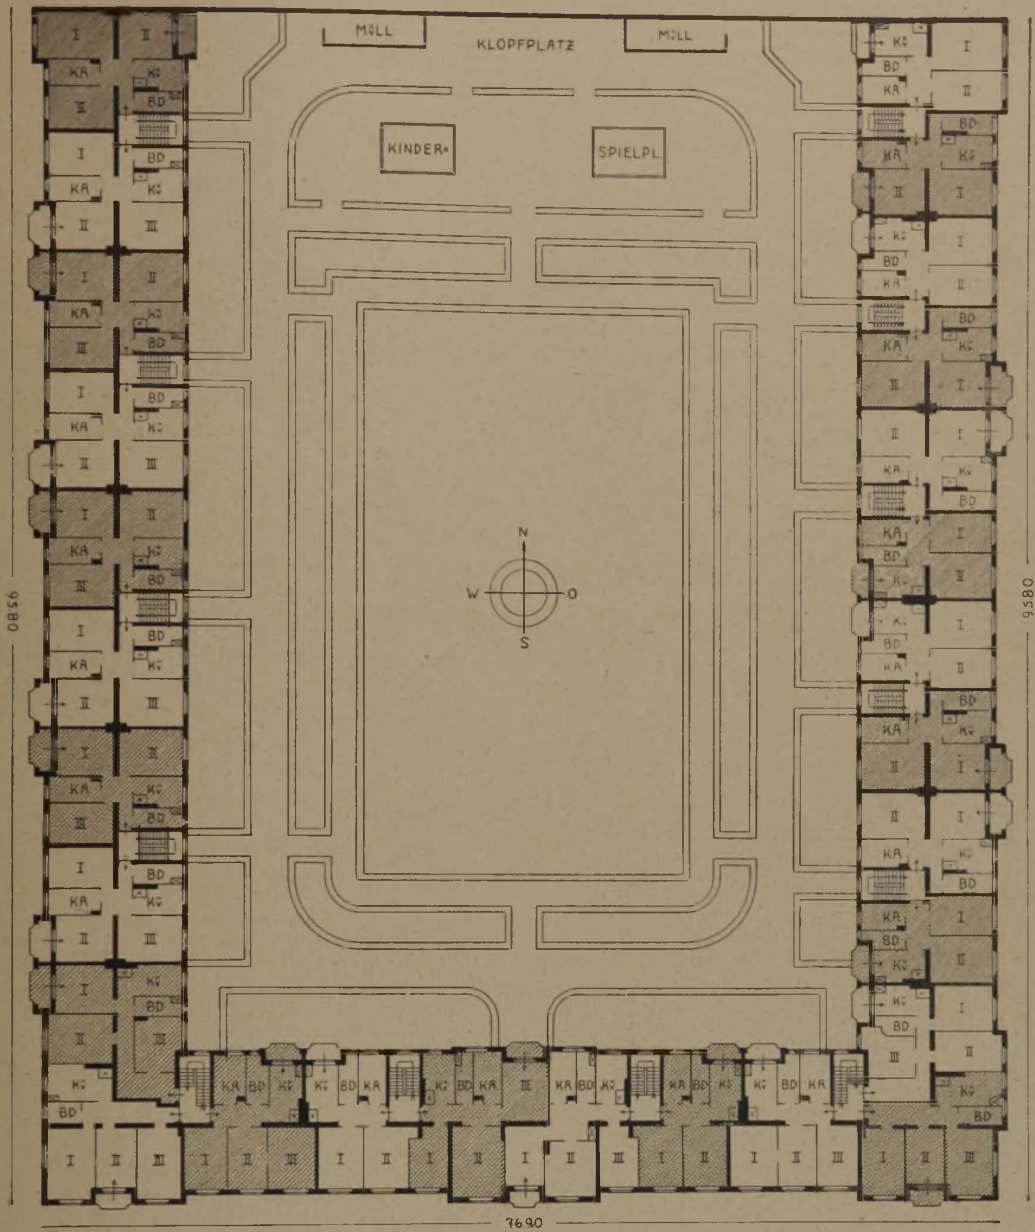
Gesamtgrundriß des Obergeschosses. (1:600.)
